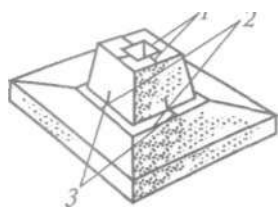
Совмещение рисок при монтаже фундамента под колонну: 1, 3 — ориентирные риски; 2 — установочные риски
